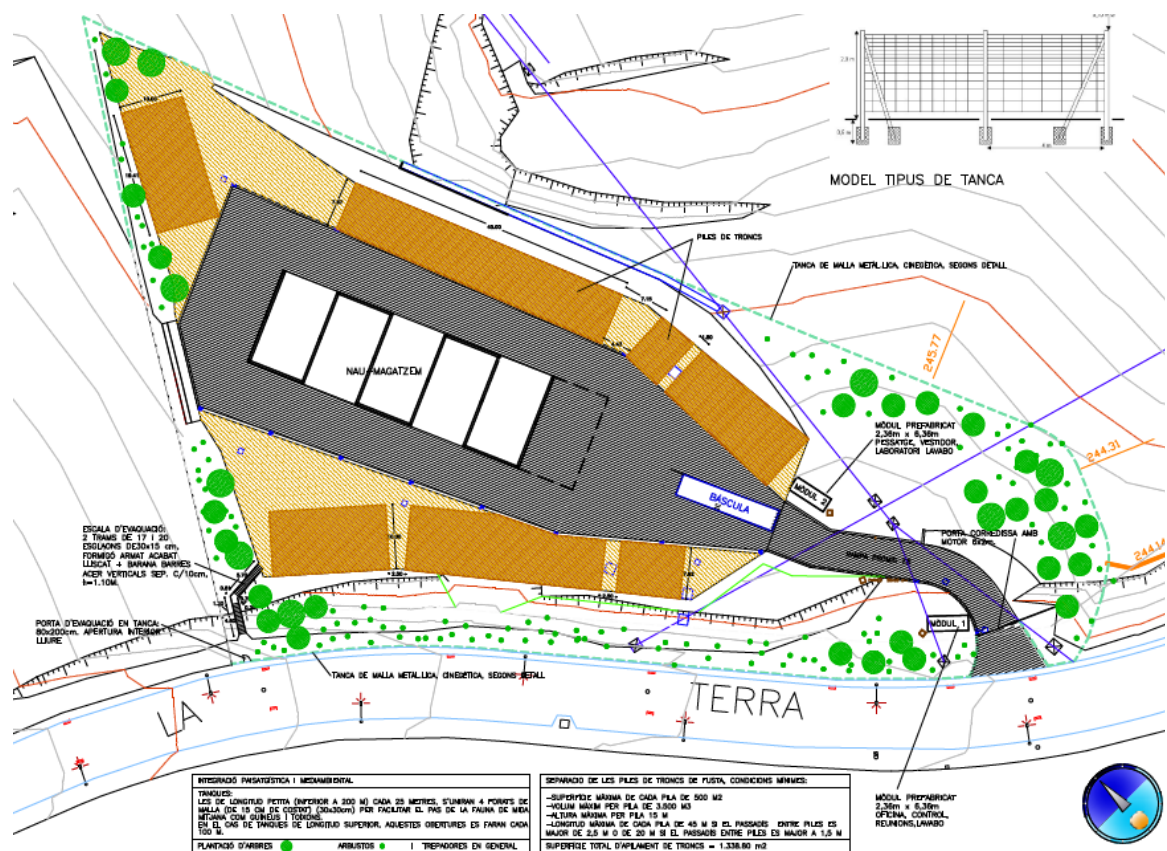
Planta general d'implantació del Centre Logístic (Font: Projecte executiu - CCVOC)
